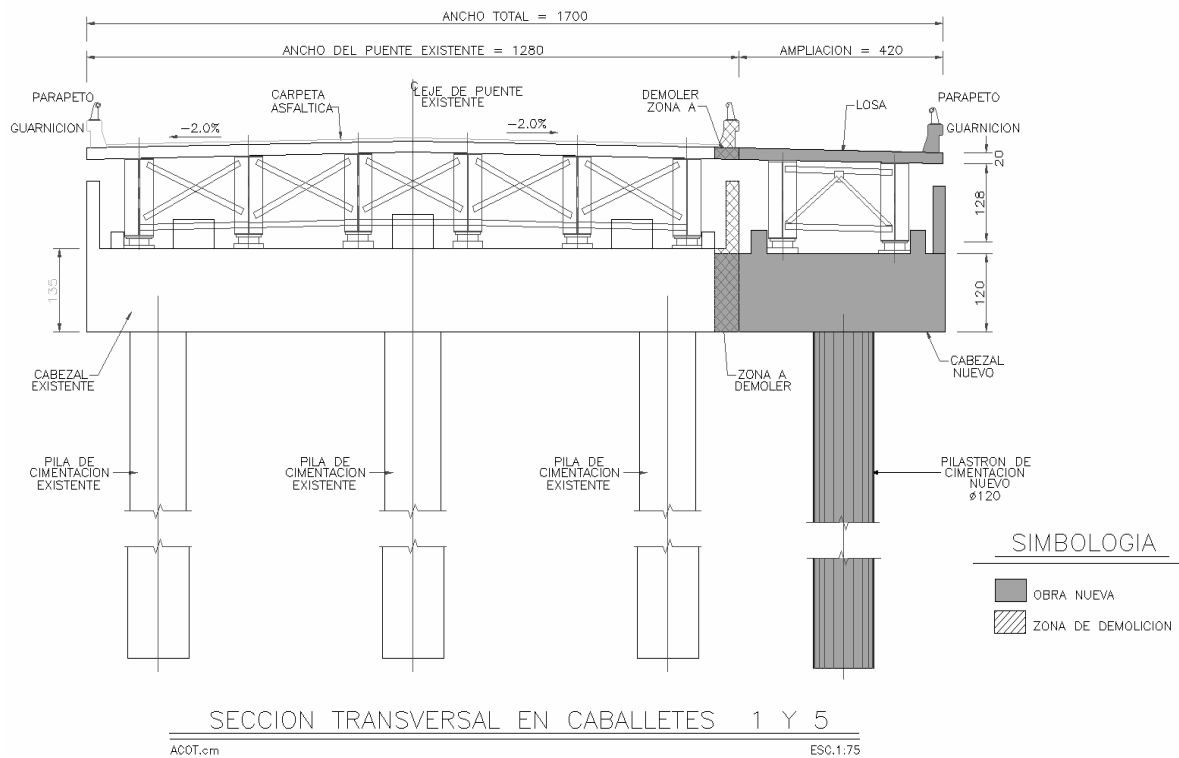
Sección transversal caballetes Puente Ixtapa.
